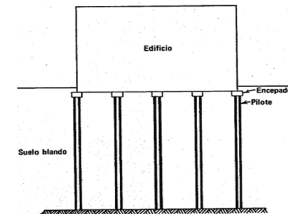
Sistema Constructivo propuesto. Elaboración Propia.
